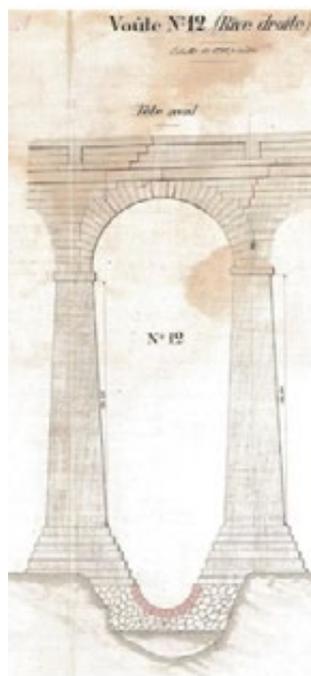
Fondation établie en 1836 sur radier général des piles du viaduc d'accès rive droite au pont sur la Dordogne à Cubzac (extrait d'archives)
